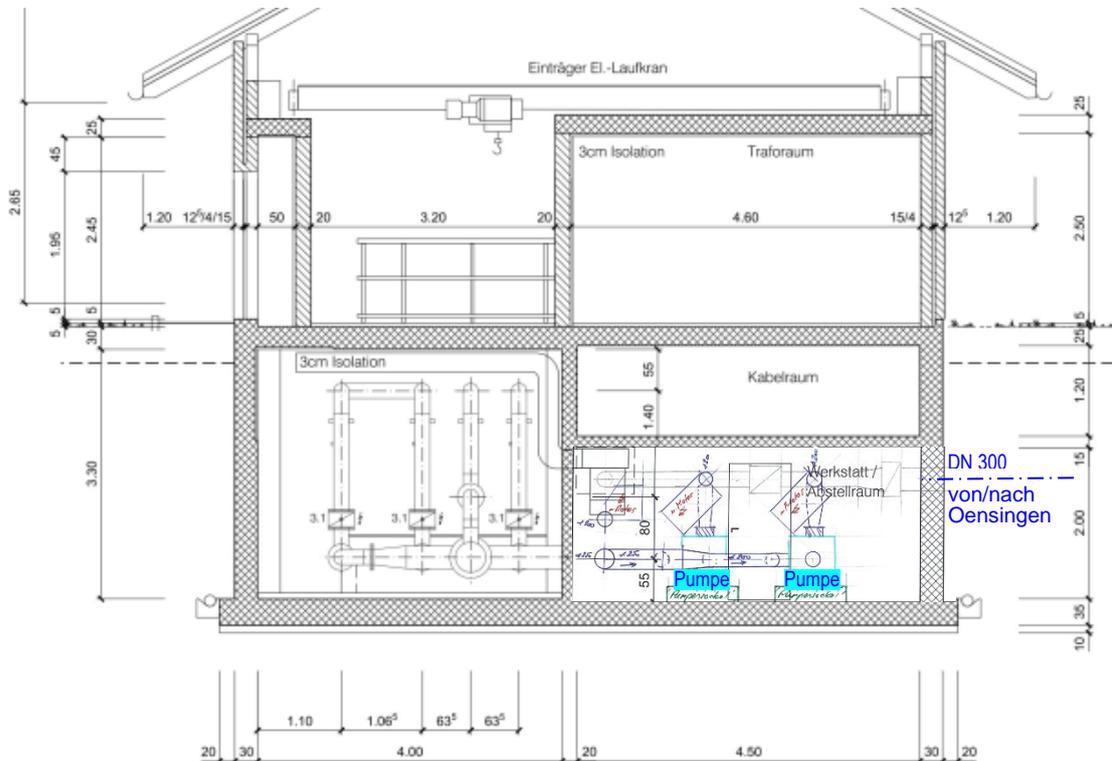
GWPW Neufeld mit Einbau Stufenpumpwerk, Schnitt C-C 1:100
